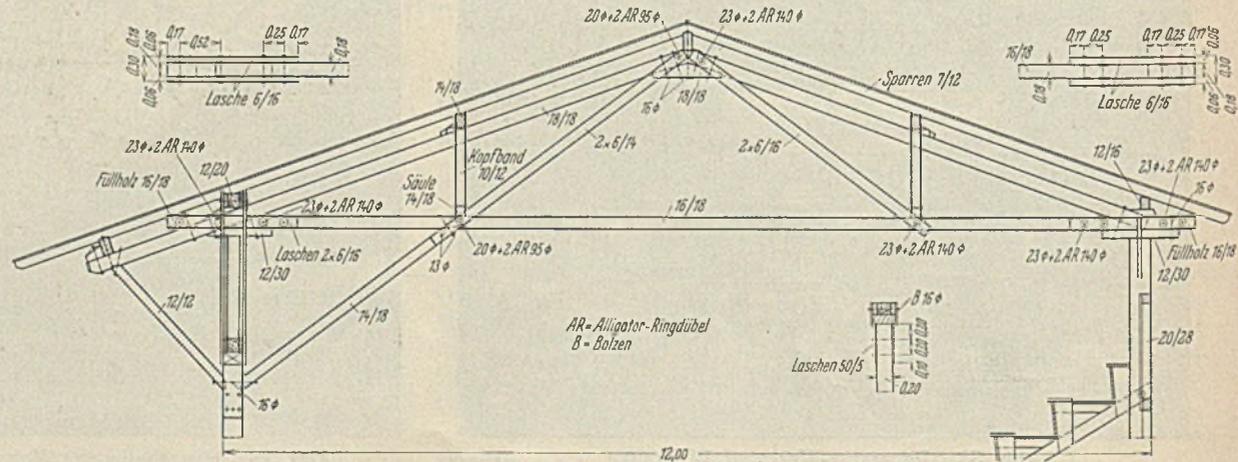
Tribüne V. f. B. Leipzig. Querschnitt mit Dachbinderkonstruktion.
